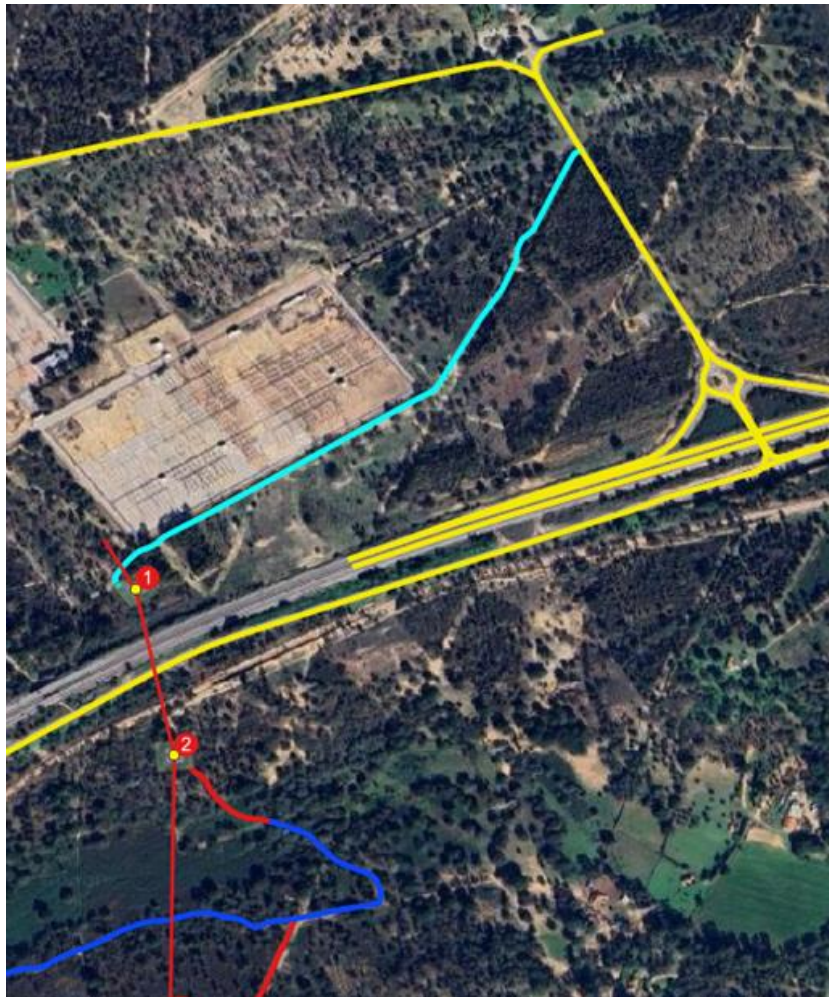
Planta de acesso ao apoio 1(SC2)
